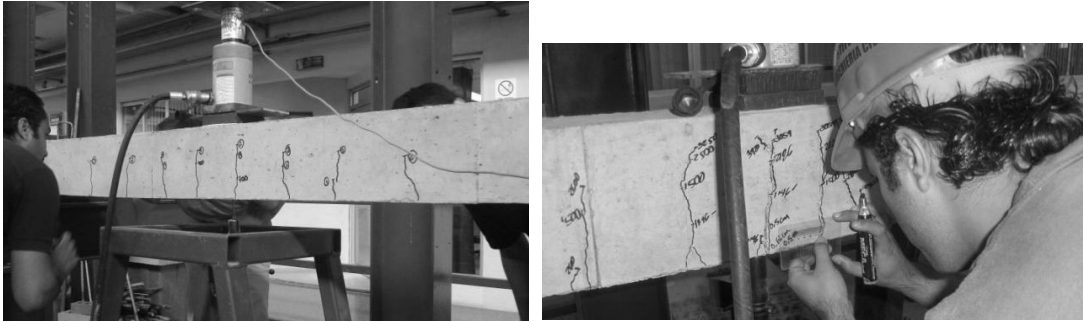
Registro de grietas durante su desarrollo y hasta la carga de falla.
